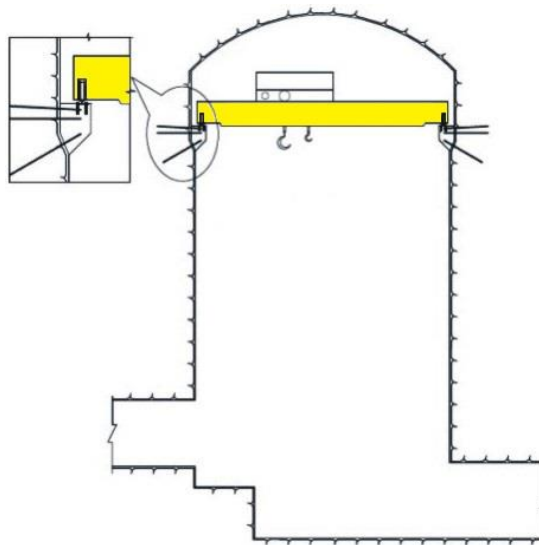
Esquema representativo de uma ponte rolante apoiada em vigas ancoradas [1]
